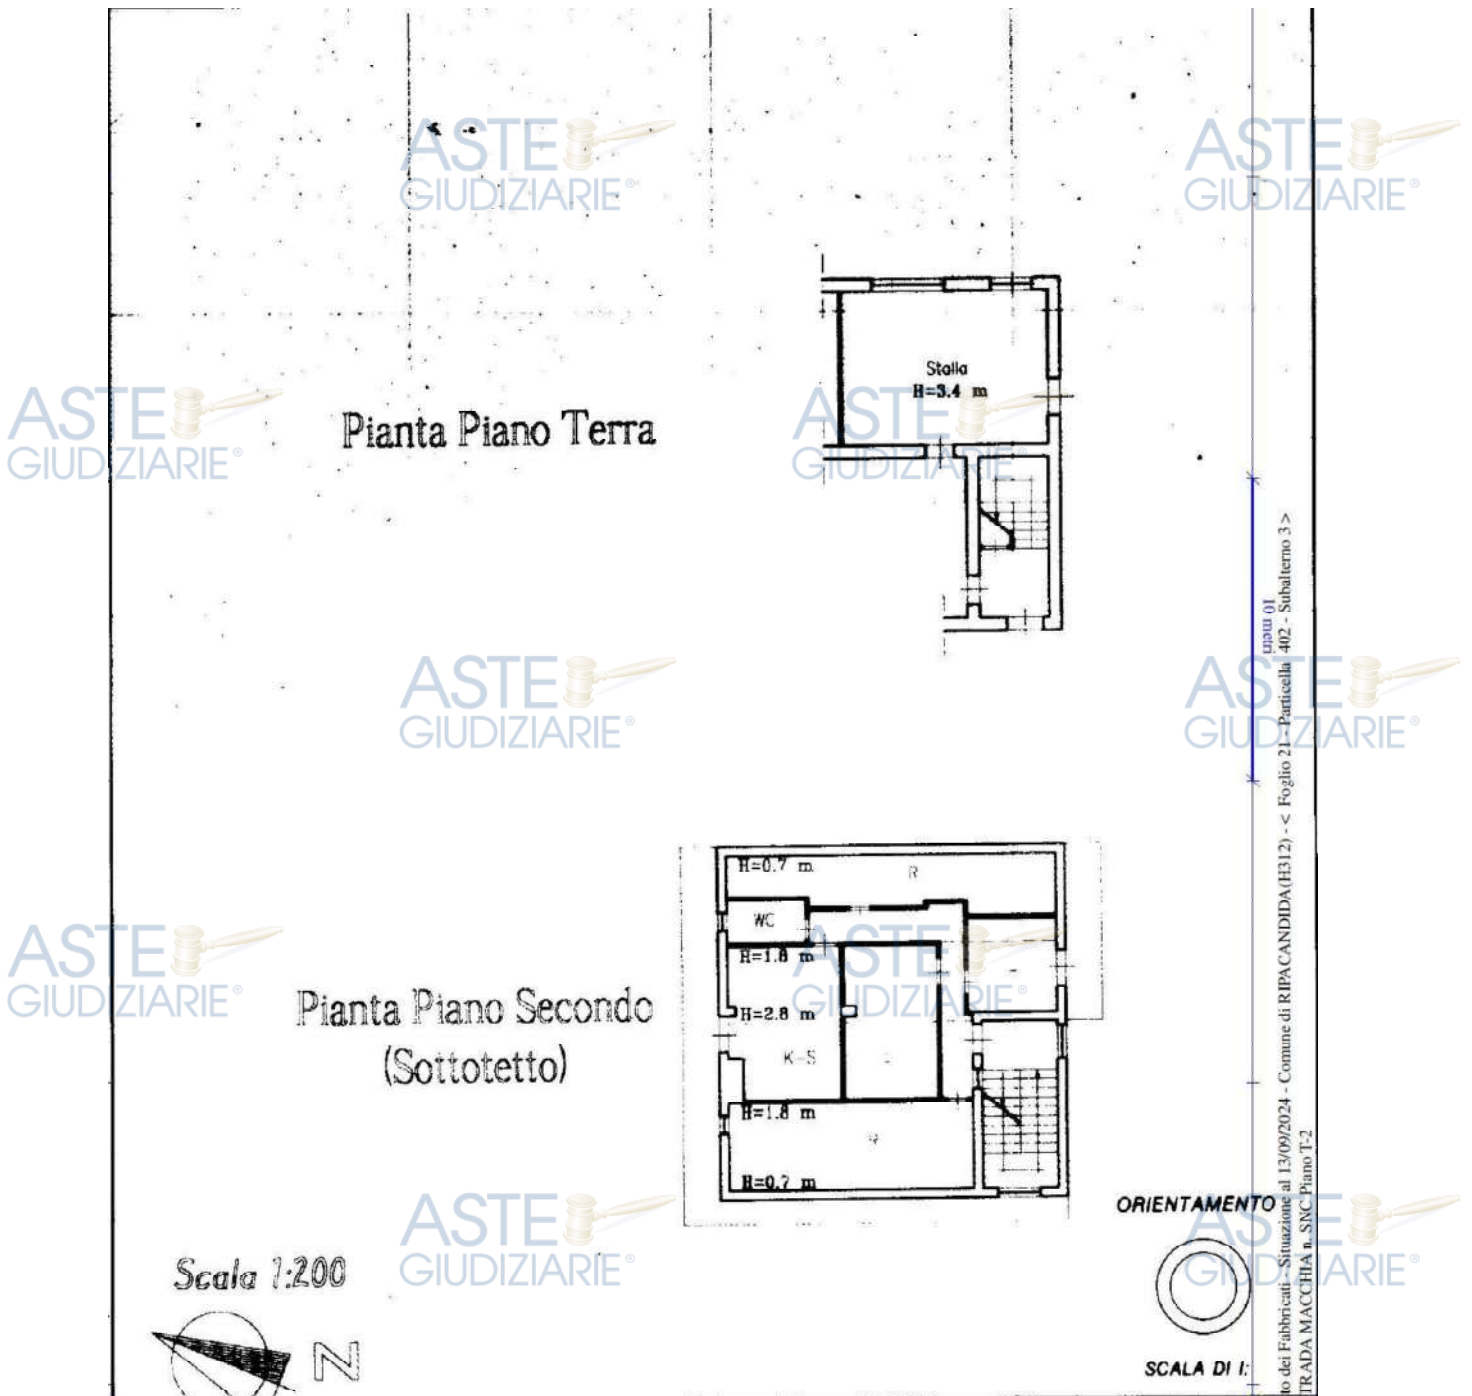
Planimetria Catastale Deposito Piano Terra e Abitazione Piano Secondo, P.Illa 402, Sub 3.
